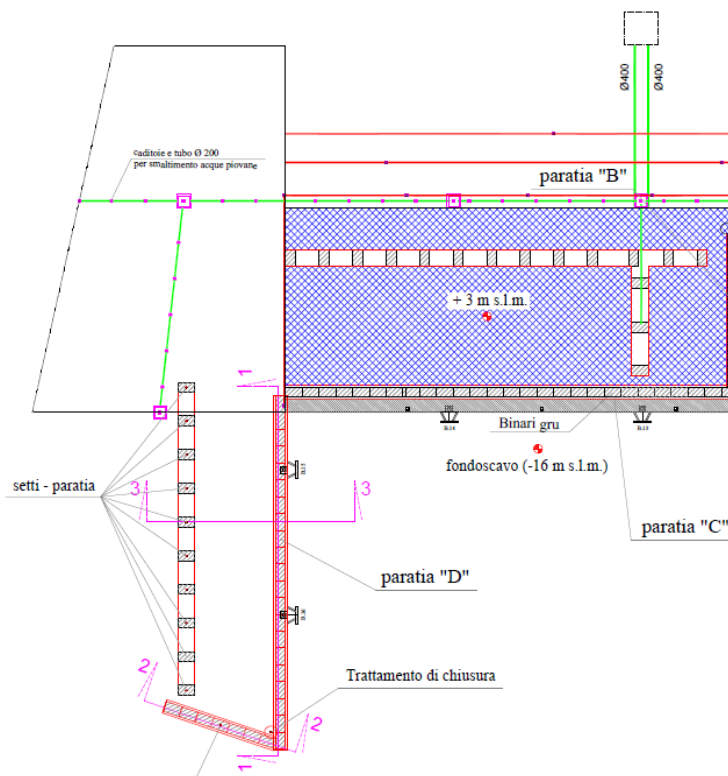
Stralcio planimetrico del progetto del banchinamento Nord realizzato: si nota l'indicazione del fondo escavo a -16,0 m da l.m.m.
